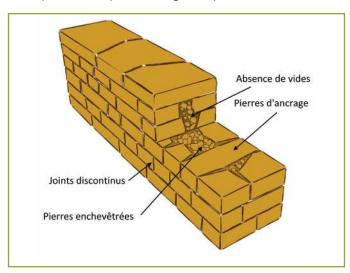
Schéma d'un mur en pierres brutes (Dessin de Cédric Houel)
